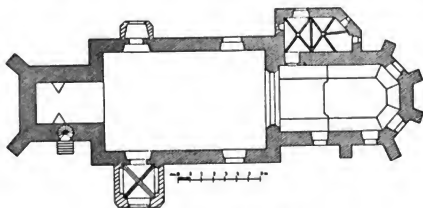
Mauth. Grundriss der Kirche.
